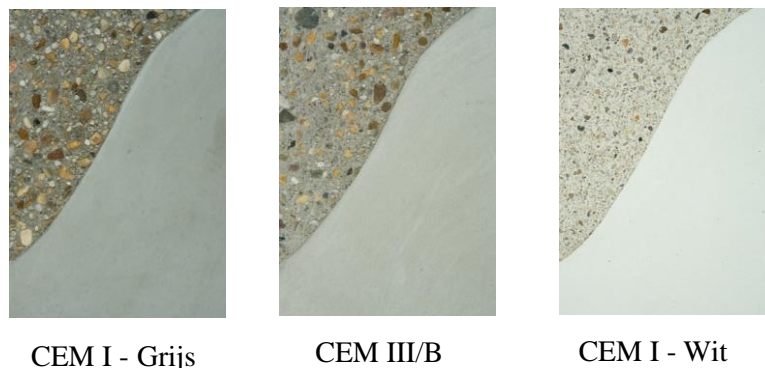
De kleur van het beton wordt bepaald door de kleur van de zichtbare kleine korrels aan het betonoppervlak.
